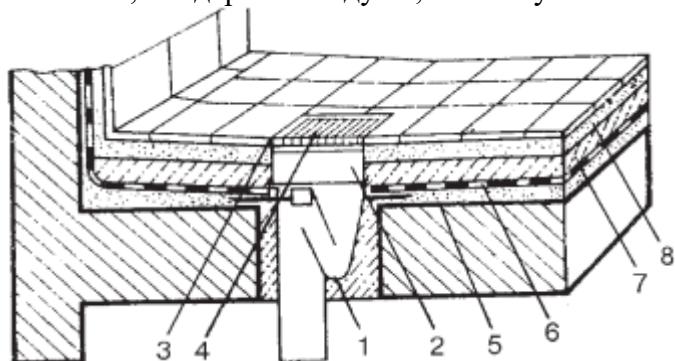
Сток воды с пола и водонепроницаемое уплотнение: 1 – сифон; 2 – промежуточное кольцо; 3 – рамка приемной решетки; 4 – решетка; 5 – бетон, уложенный с уклоном в сторону стока воды; 6 – водонепроницаемое уплотнение; 7 – защитный слой бетона; 8 – цементный раствор
